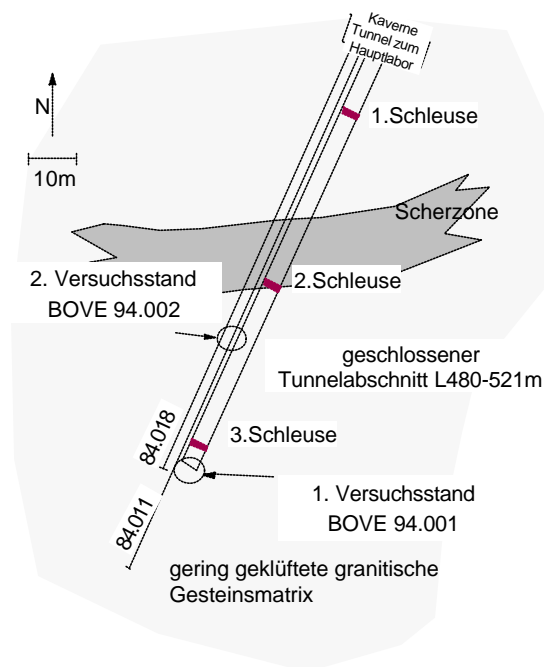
Lageplan der Versuchsstände im Ventilationsstollen.
